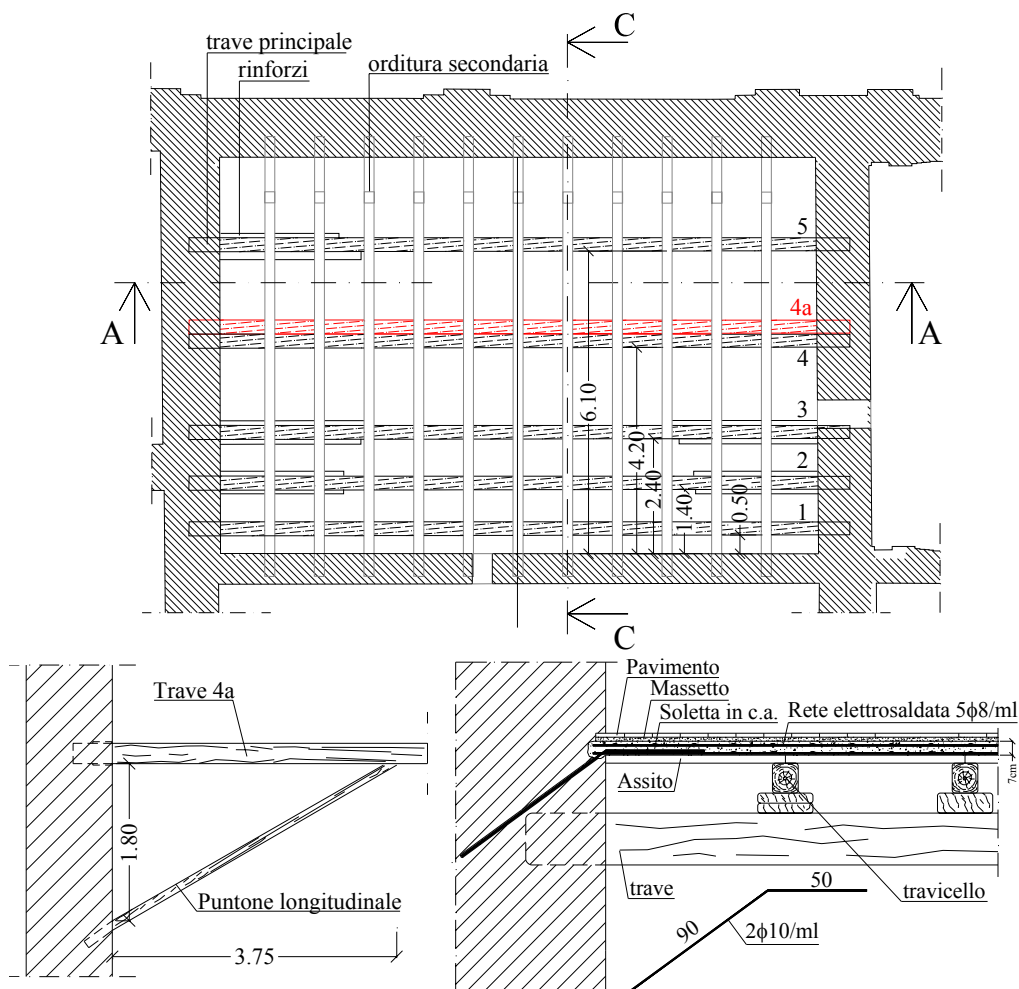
Consolidamento solaio: a) Carpenteria del solaio dopo l'intervento; b) Irrigidimento trave 4a; c) Sezione solaio.
